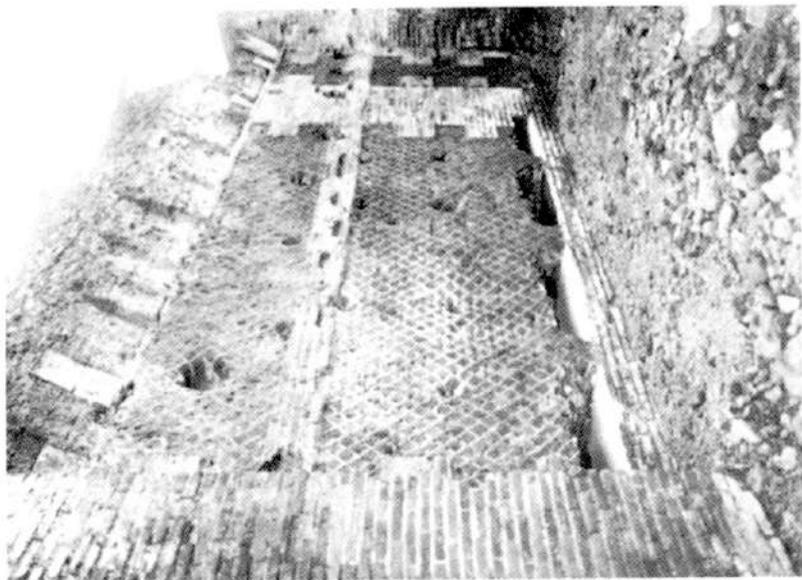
Murature in opera mista dall'Insula delle Pareti Gialle
